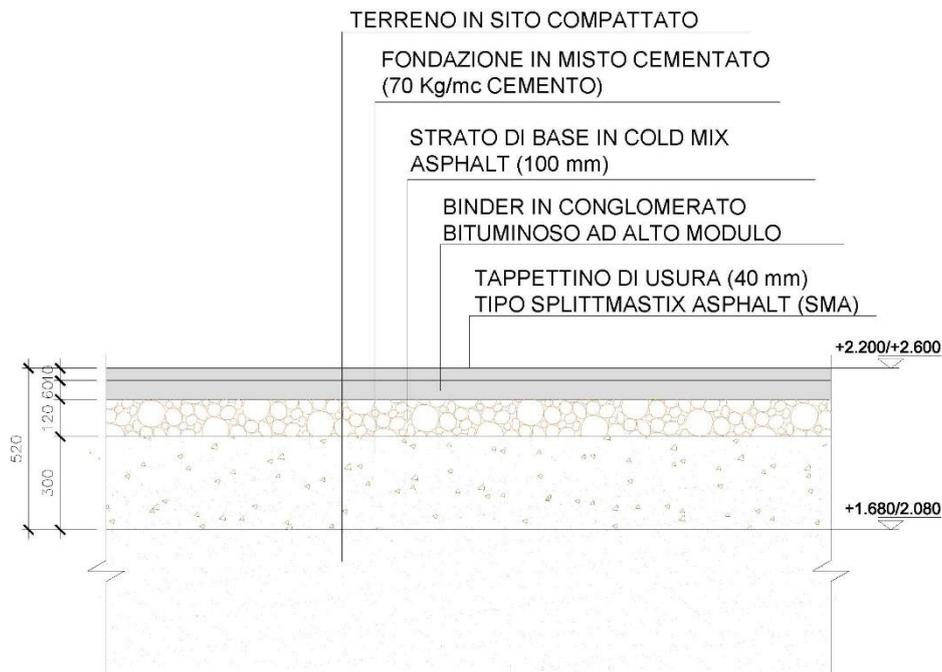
Pacchetto di pavimentazione piazzali e viabilità.
